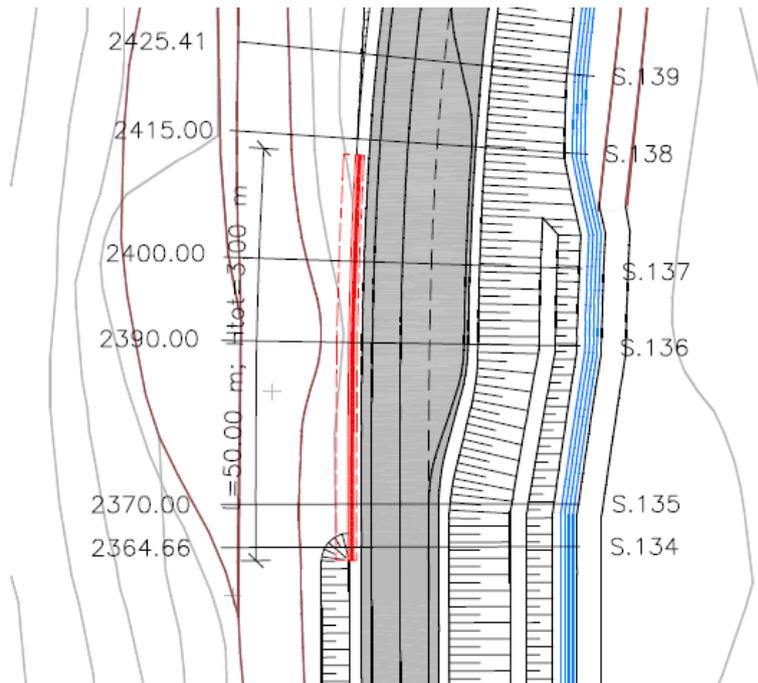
Muro di controripa nel tratto Ovest di fine lotto in continuità a portale di imbocco della galleria
